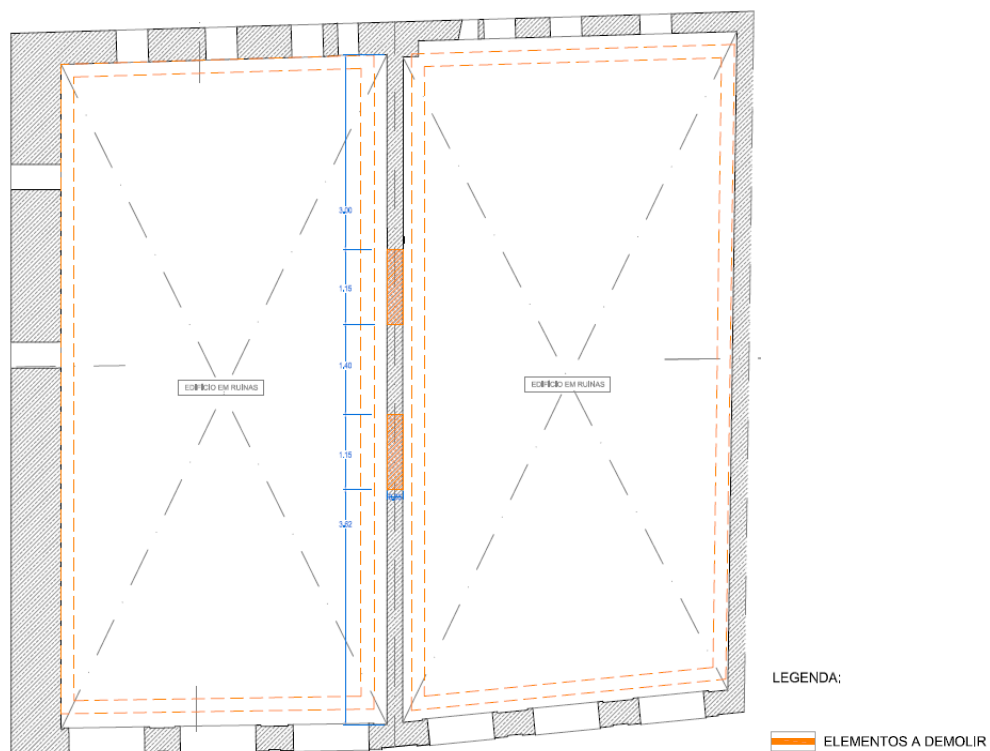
Planta do 2º piso com elementos a demolir - Fonte: Desenhos de Arquitetura da Operação E2 - Projeto
